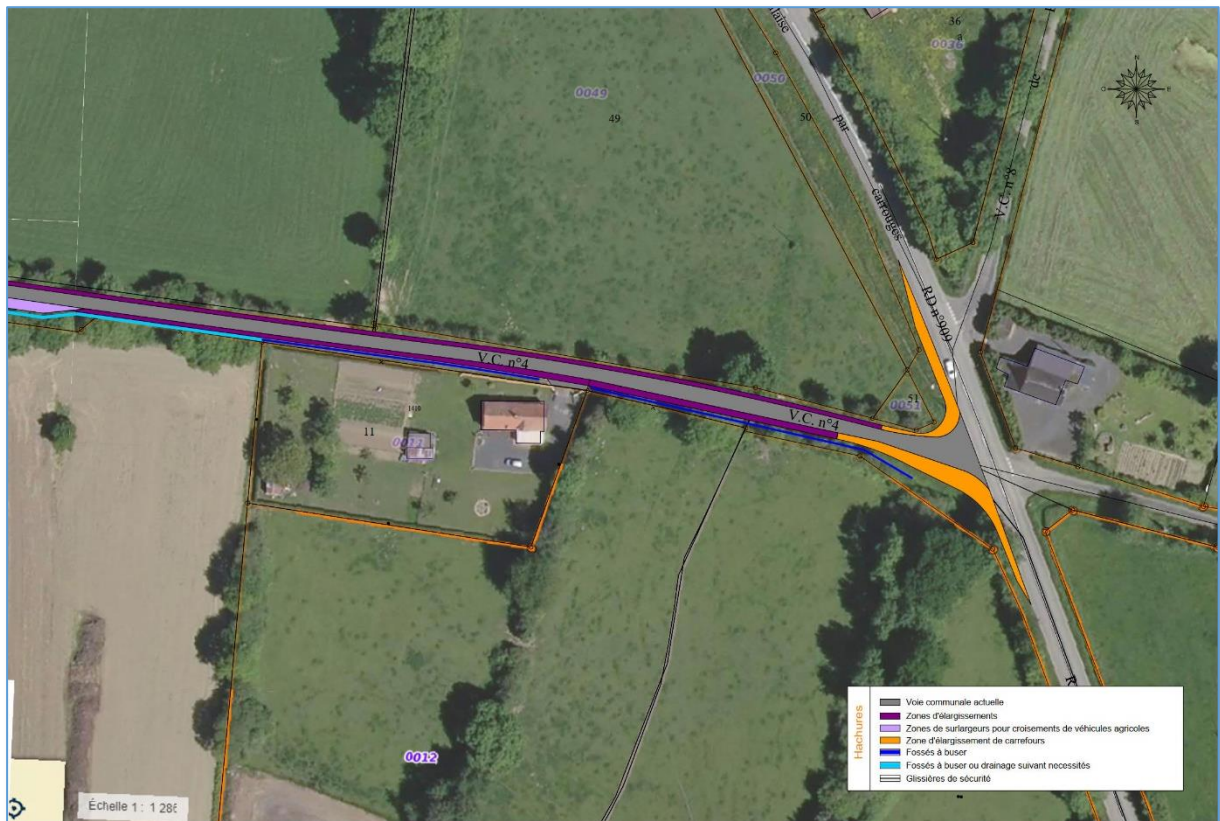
Aménagement routier de la voie communale n°4 – Plan n°6
